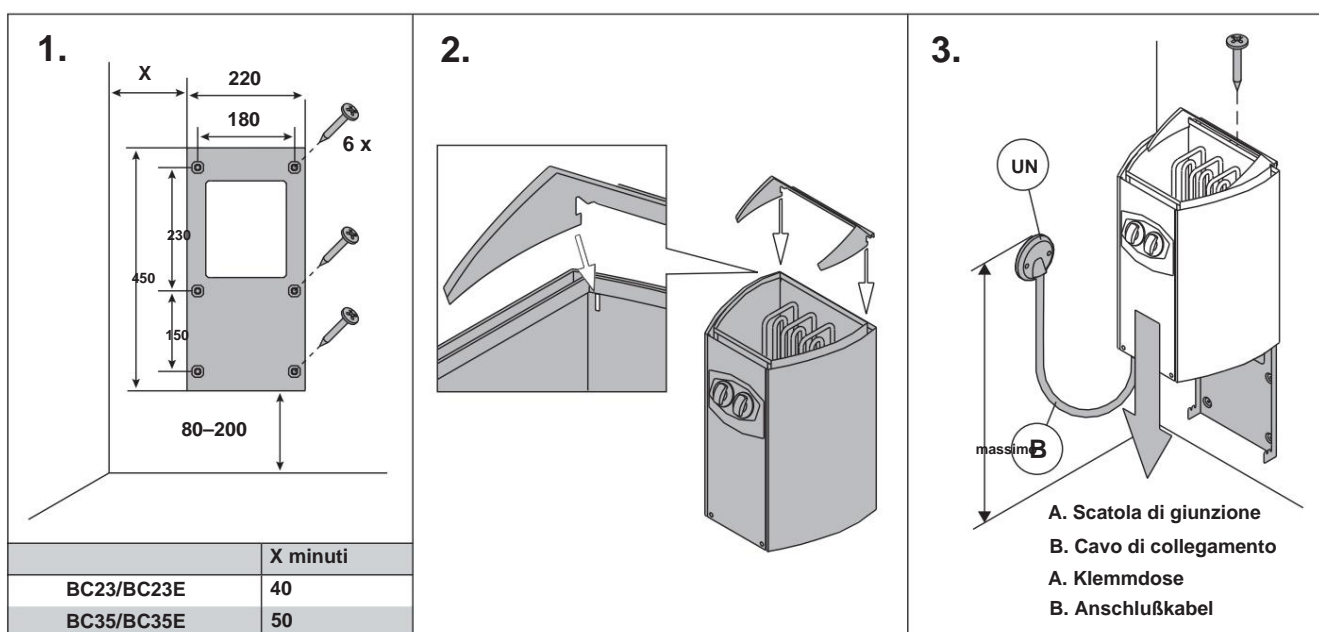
Fissaggio del riscaldatore a parete (tutte le dimensioni in millimetri)
